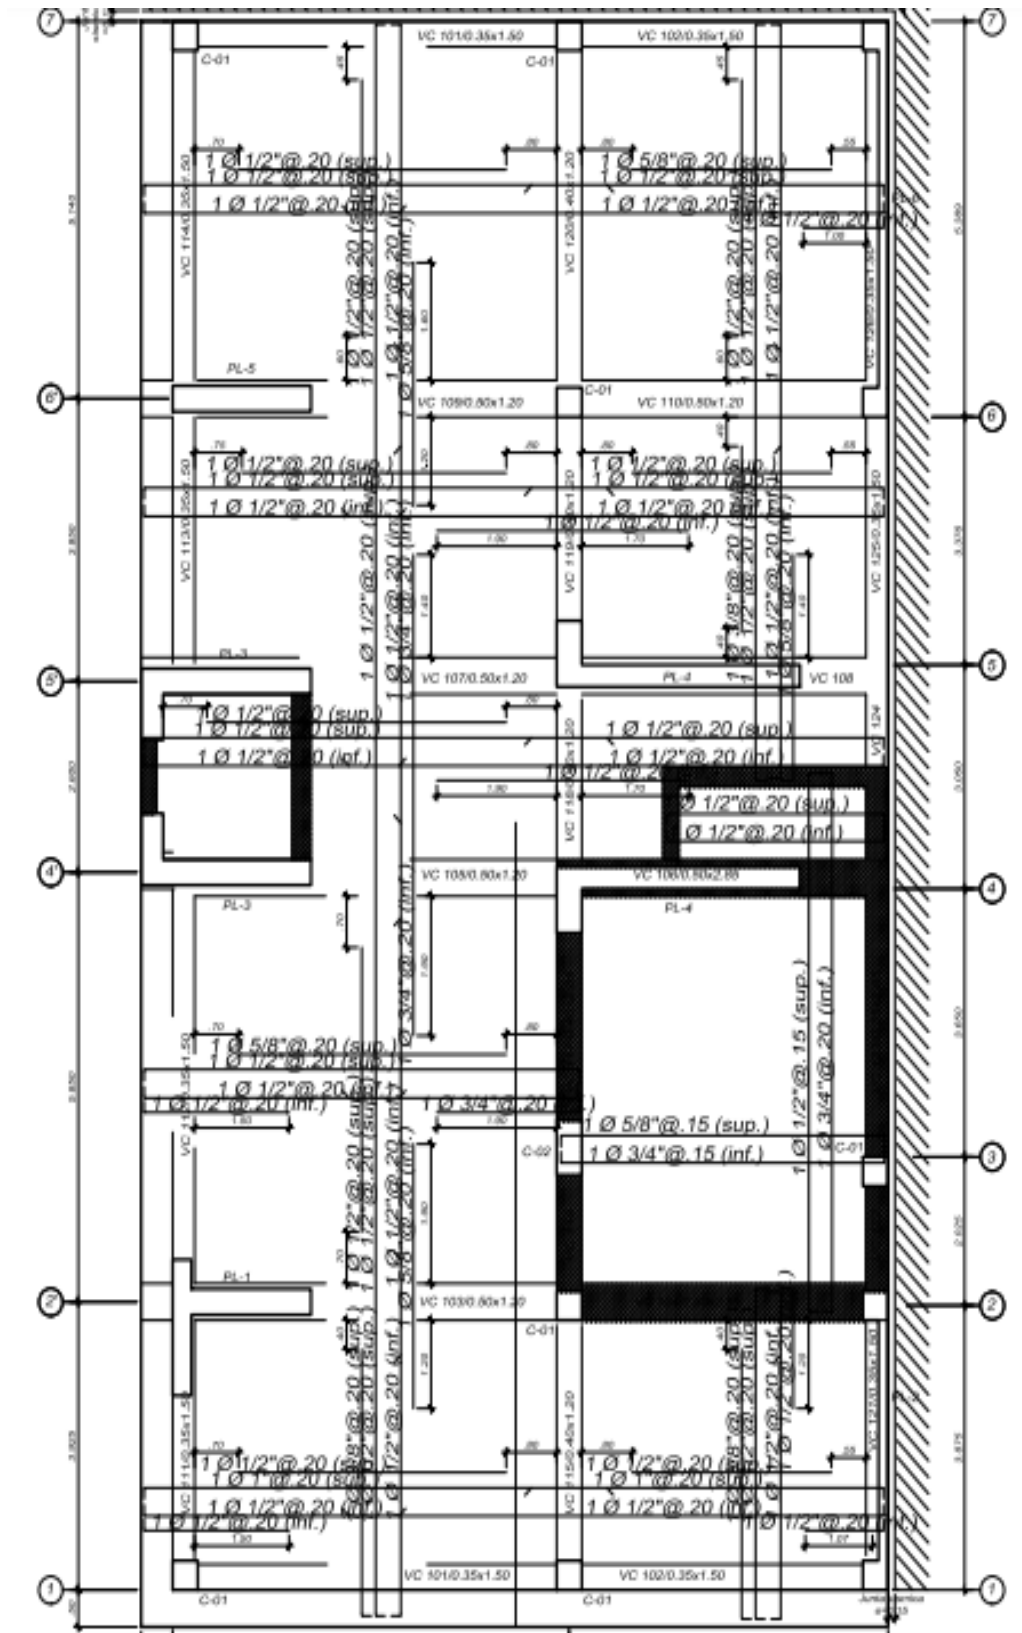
Detalle del reforzamiento en la losa de cimentación 1cr
